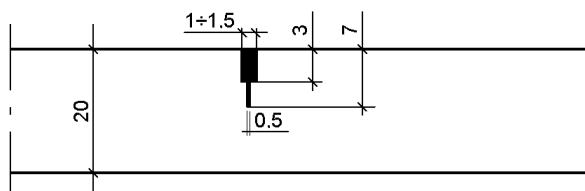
Przykłady konstrukcji szczelin w podbudowie z betonu cementowego
